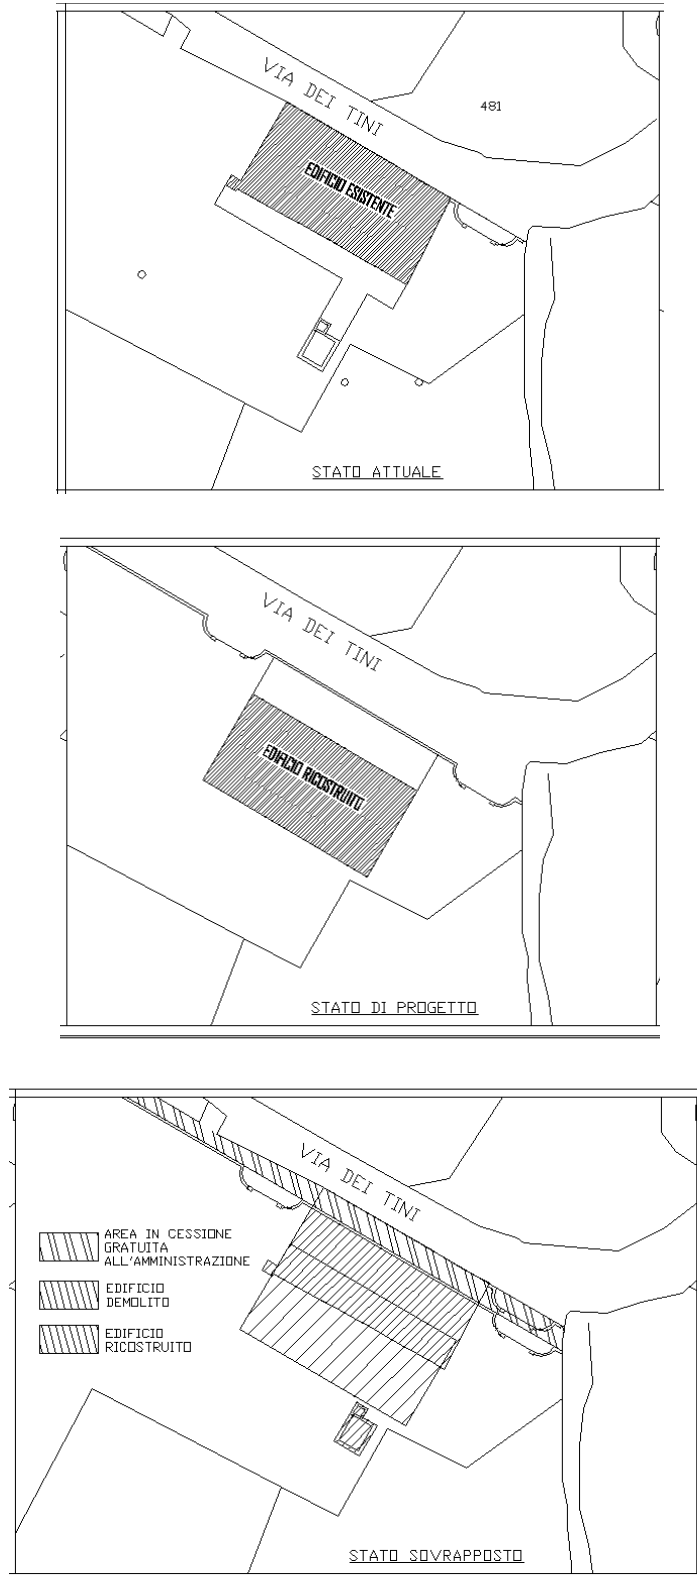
Planimetria generale: attuale – di progetto – sovrapposto.
